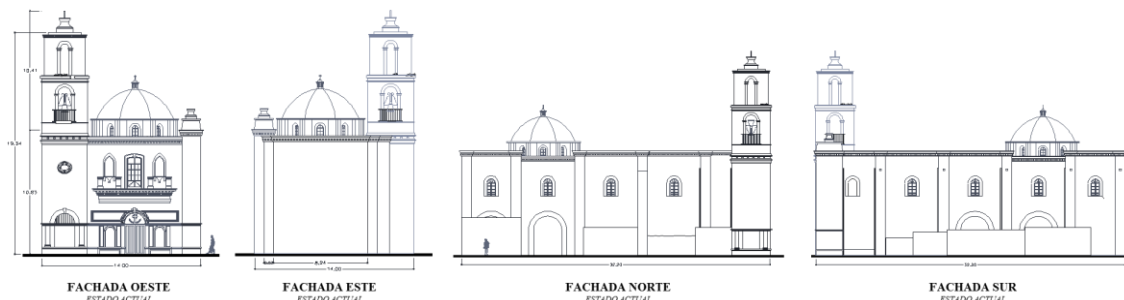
Fachadas de la parroquia de San Bernardino. (Espinosa M. 2018)
